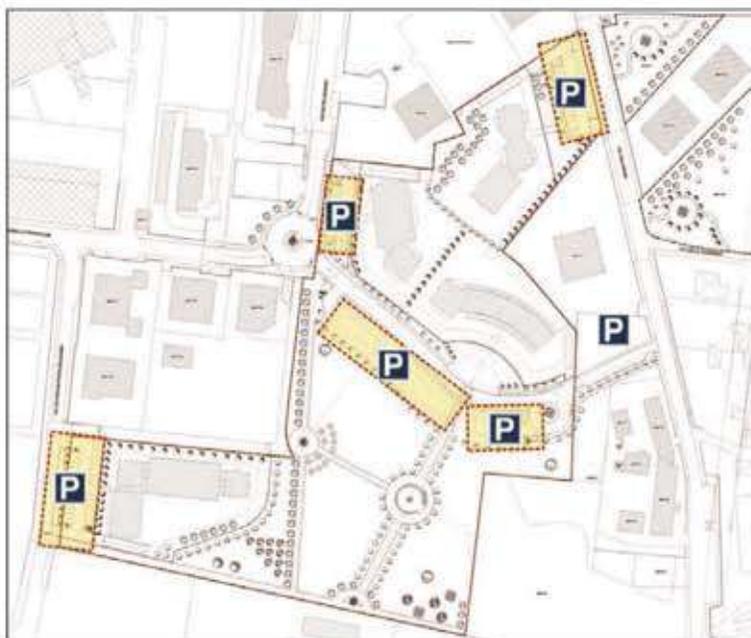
Planimetria di progetto - Aree parcheggio previste
